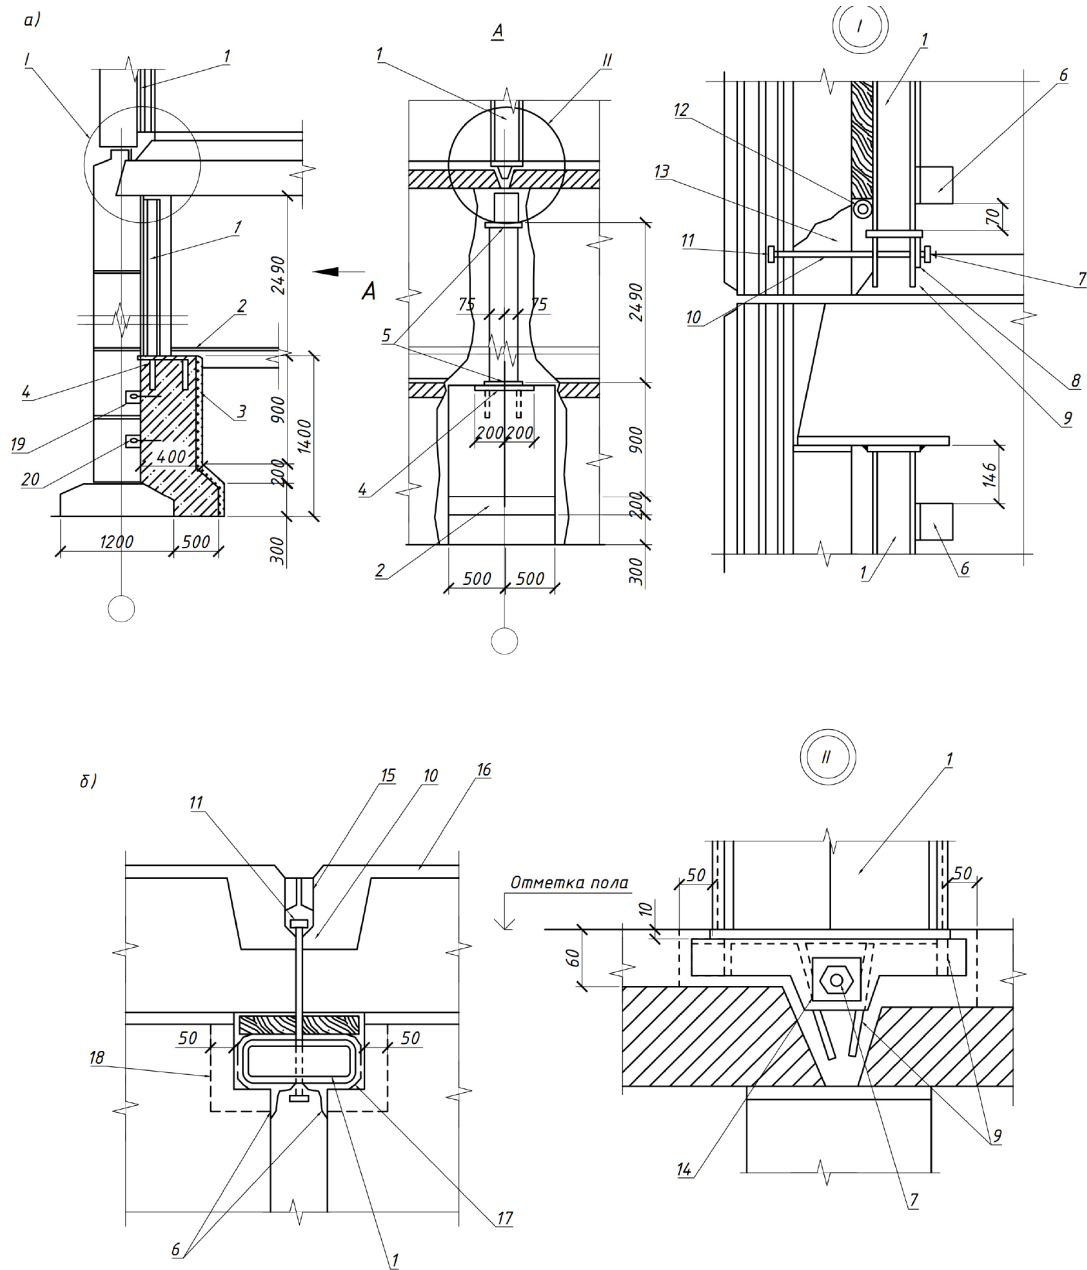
Усиление конструкции опирания прогона на наружную стену.
